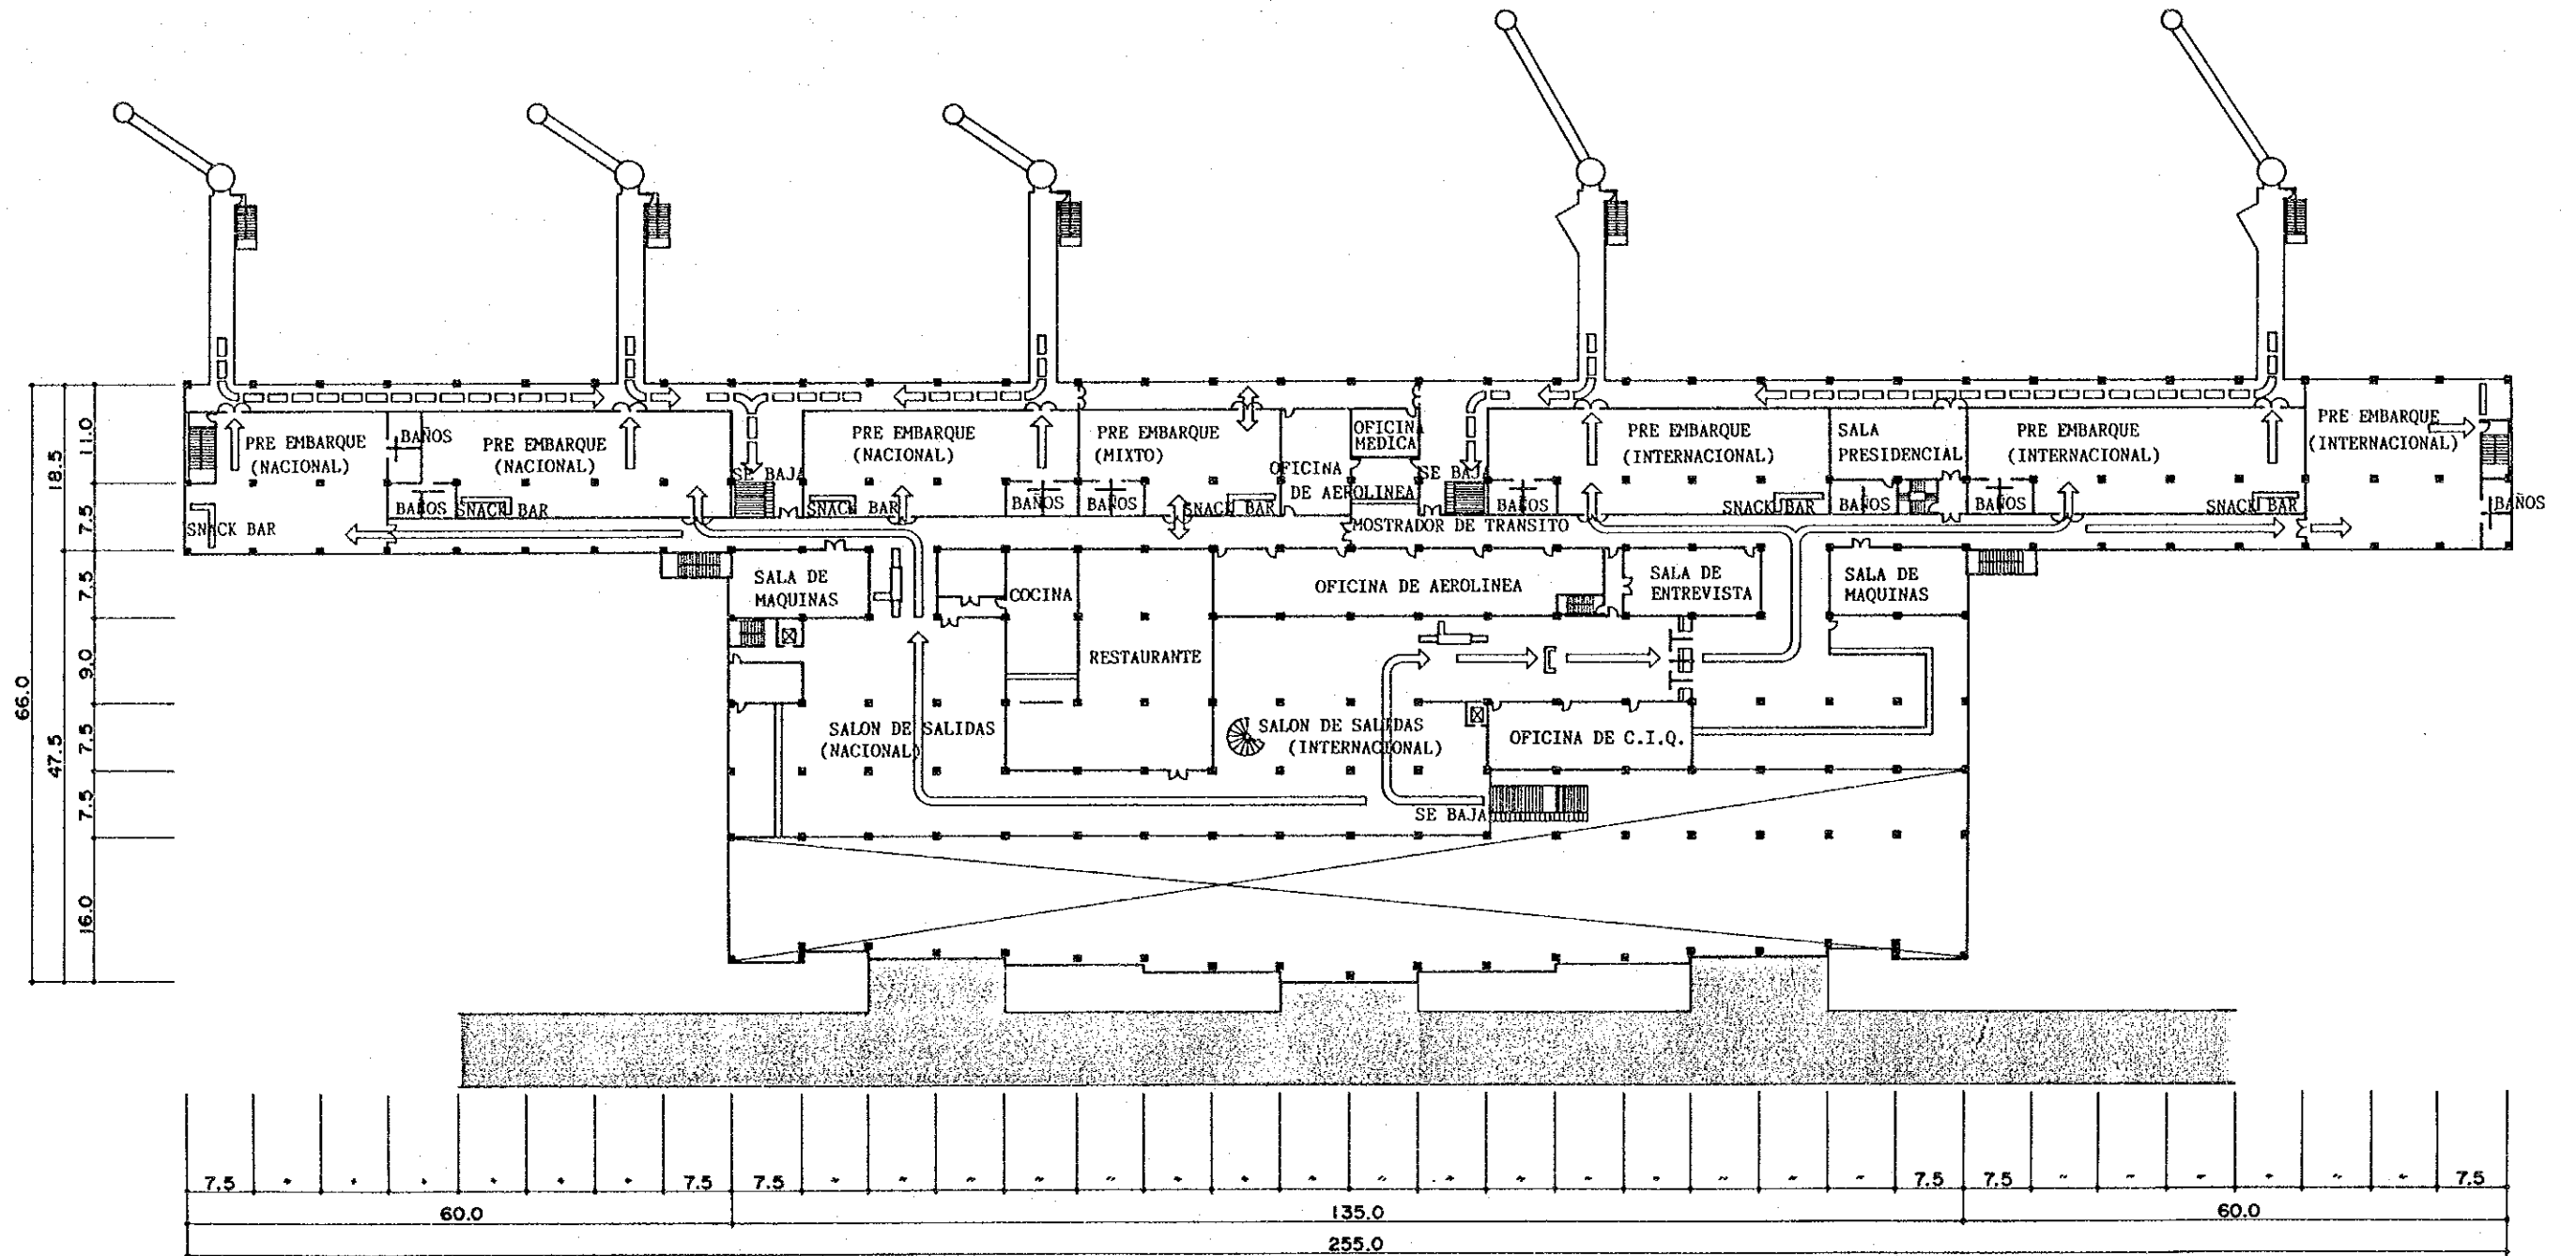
Plano del Primer Piso del Edificio Terminal de Pasajeros
